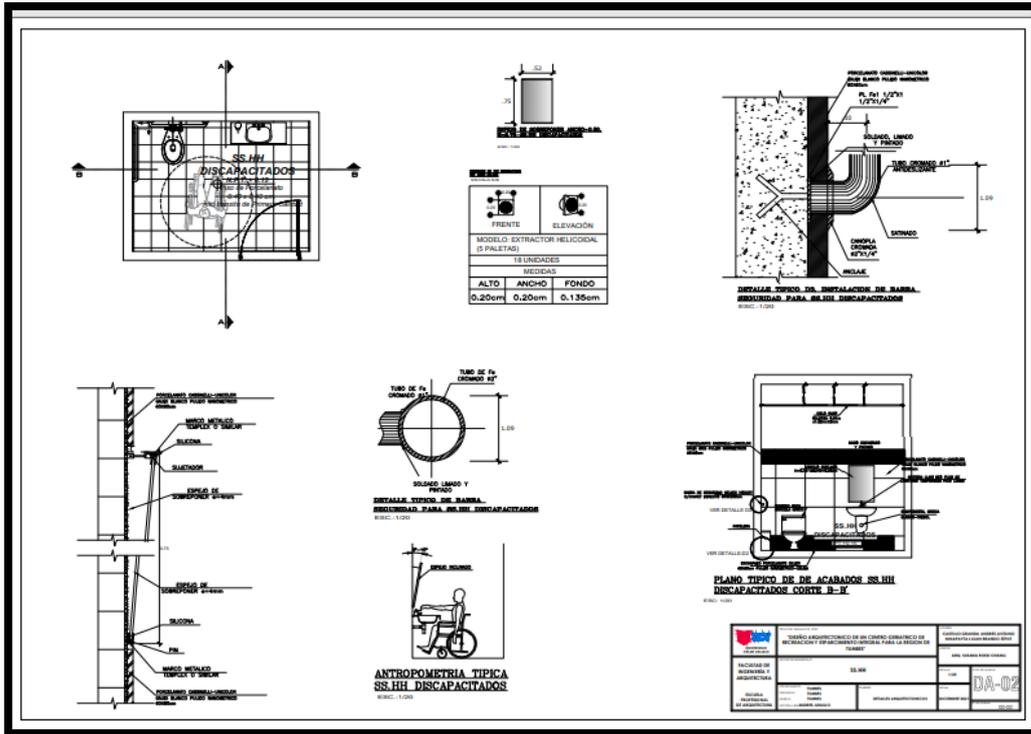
"Plano Detalles Arquitectónicos"- Fuente: Elaboración Personal.
